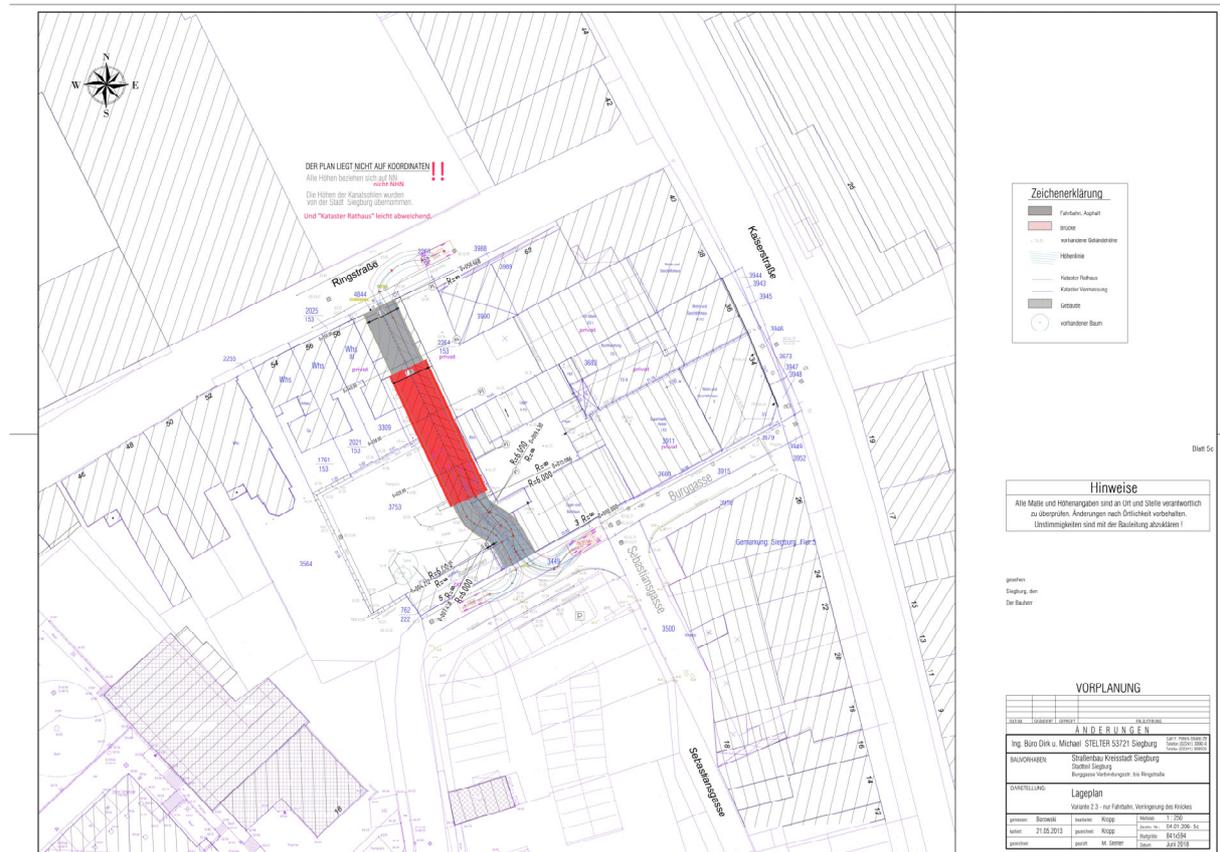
Vorentwurfsplanung Anbindung Burggasse Ringstraße, Lageplan Variante 2.3, Ing.-Büro Stelter, 2018
